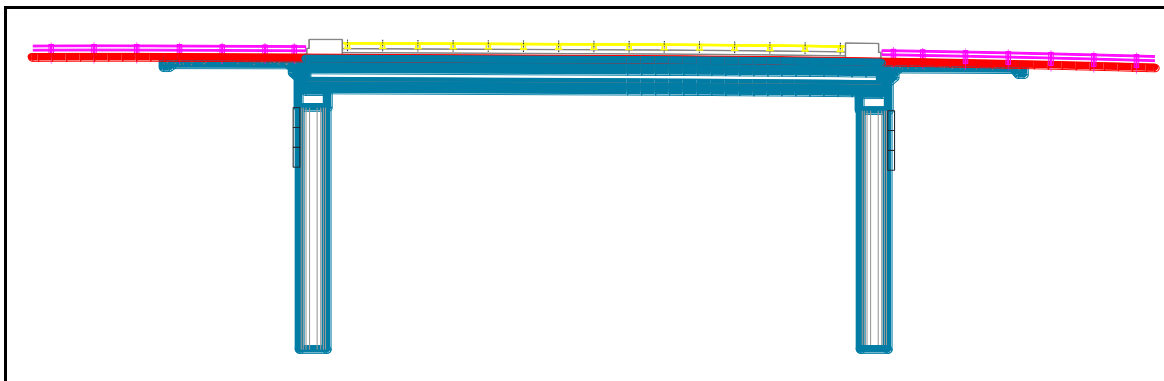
Esquema del Puente “Vado”, (Anexo 1: Planos del proyecto).
